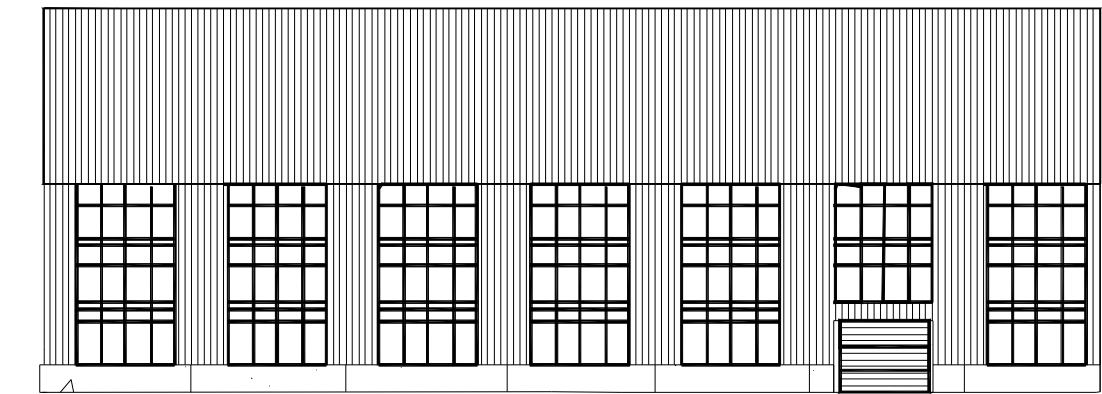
Схема раскладки крупных панелей для продольных стен одноэтажных промзданий.
